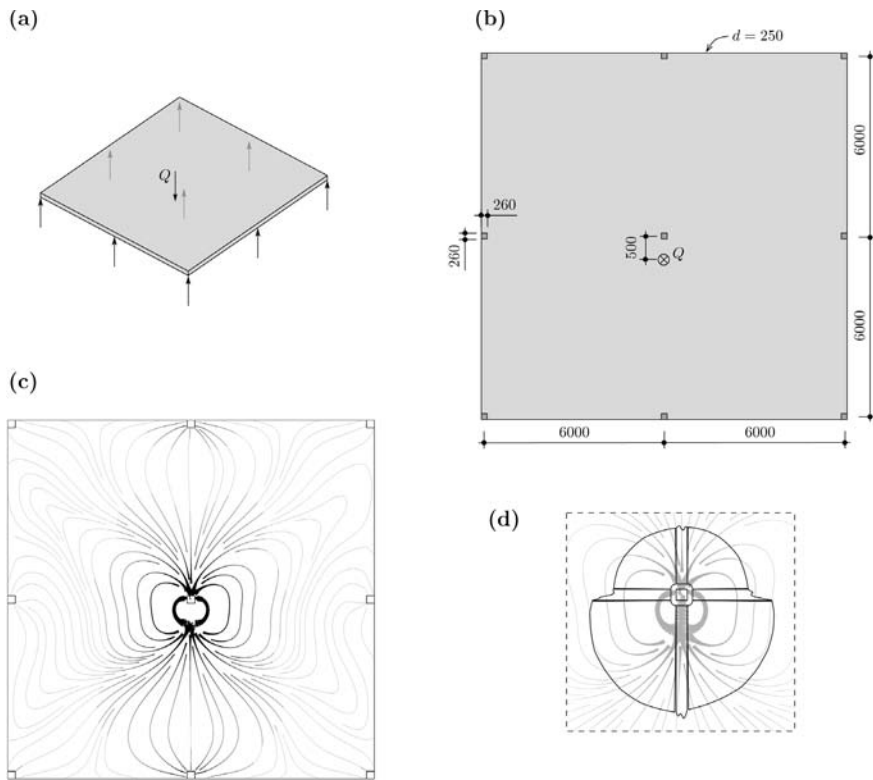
Losa apoyada sobre nueve columnas simplemente apoyadas y sometida a una carga puntual: (a) esquema de la losa y cargas; (b) dimensiones (cotas en [mm]); (c) campo de esfuerzos cortantes; y (d) reparto de los esfuerzos cortantes alrededor de la columna central.
